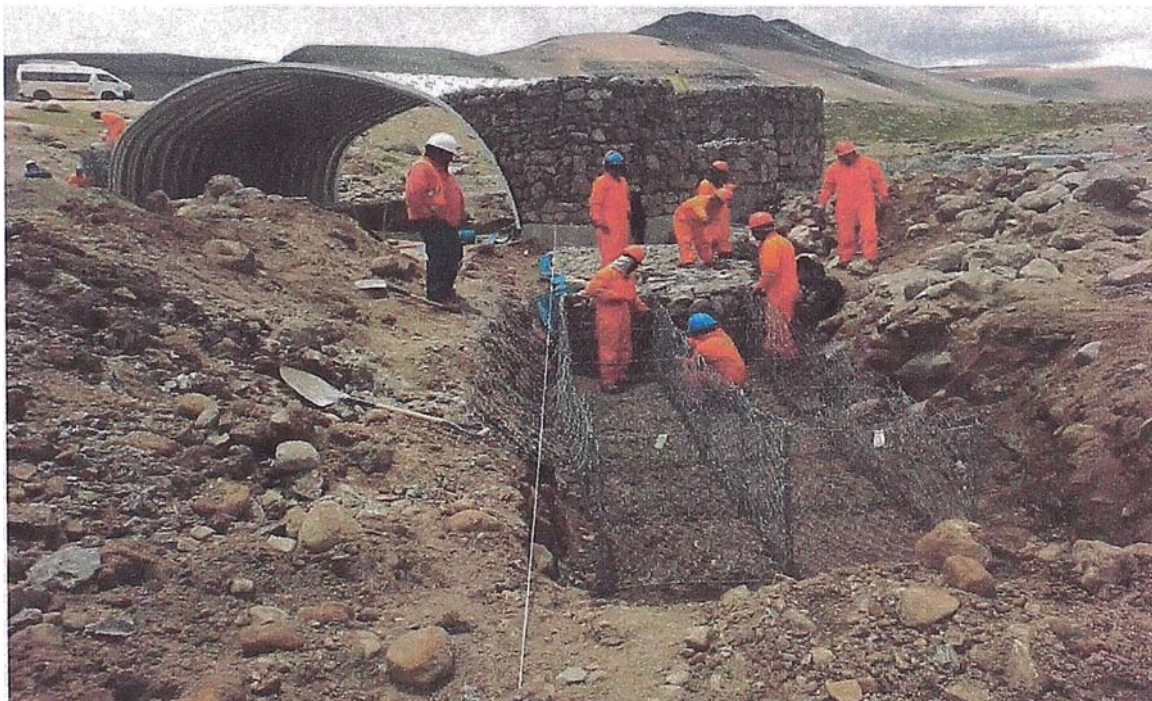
Trazado de Ubicacion de Gaviones - Muro de Encausamiento
